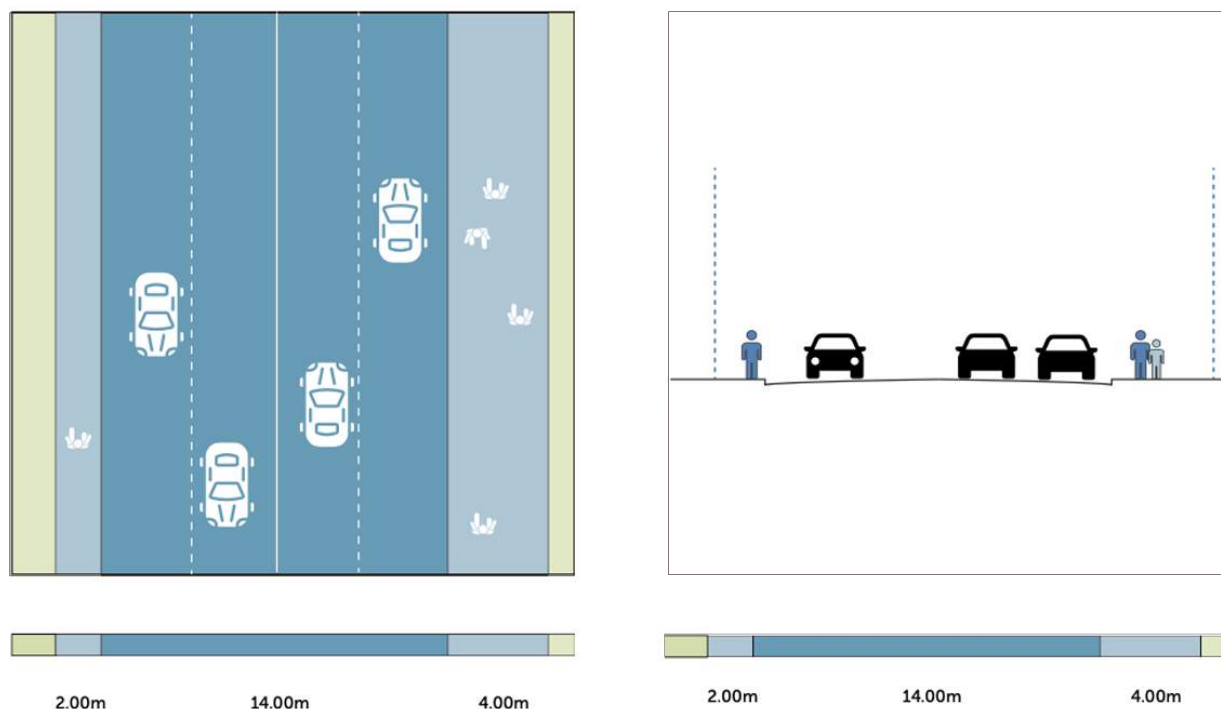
Strada Eliberării: reprezentare în plan și secțiune transversală, sursă: autor
